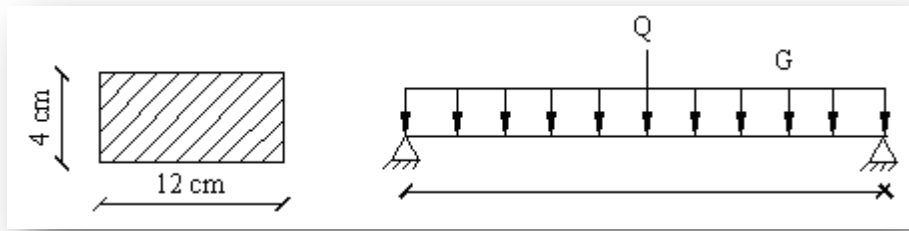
Schématisation de la poutrelle avant coulage.
